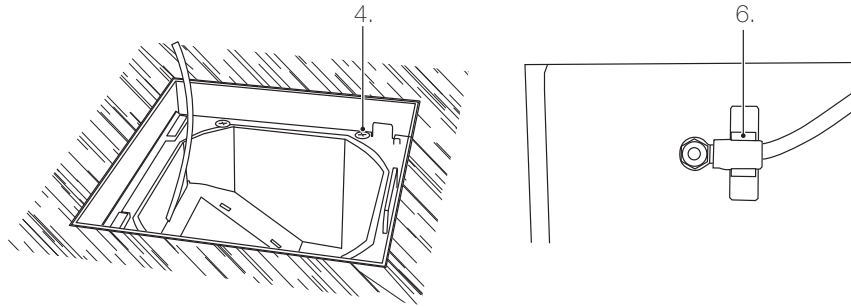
BDVE – Montage de la cuvette et fixation du couvercle
